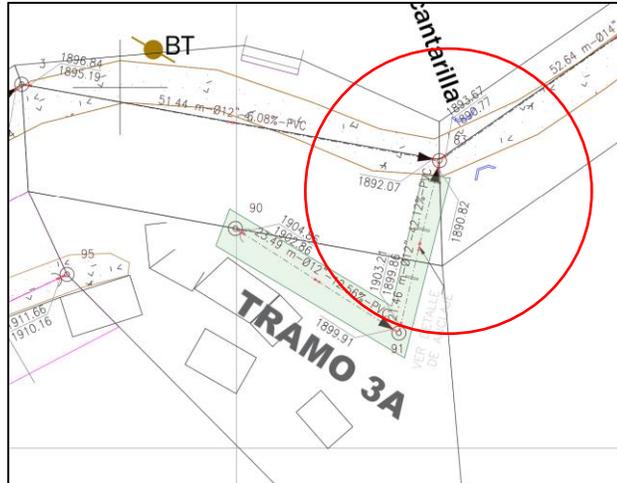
plano planta alcantarillado. Fuente: Consultoría.
